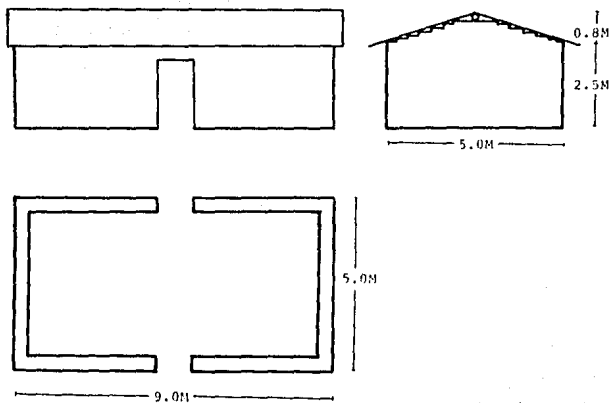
CASA TIPICA EN AYUTLA, GRO.
